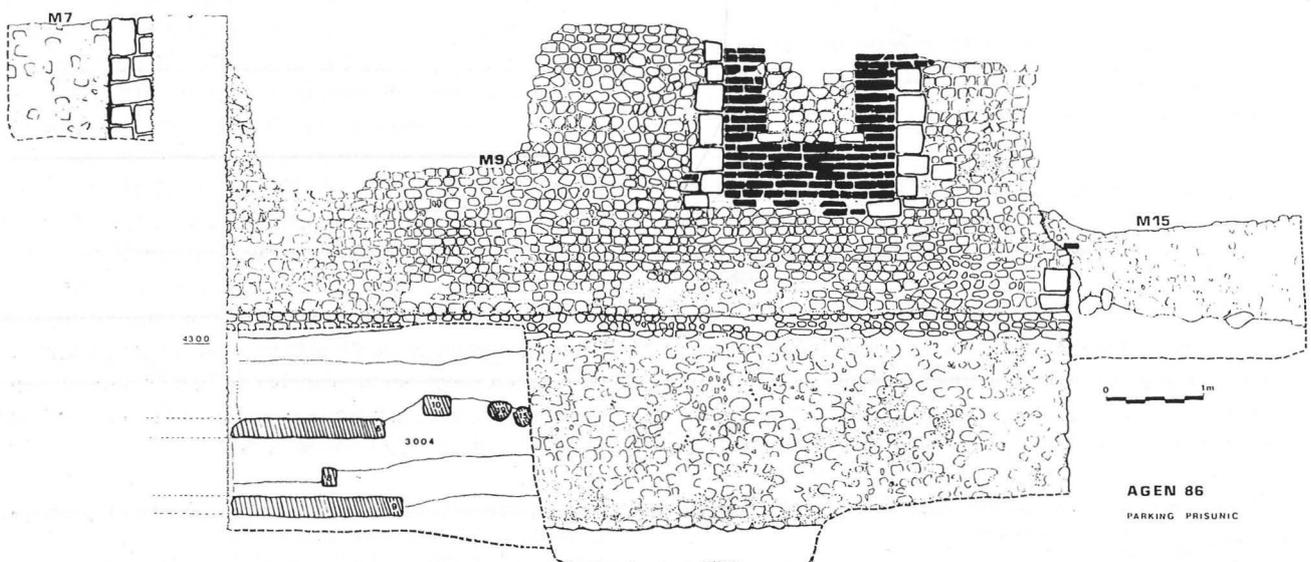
Elévation du mur (M9) du premier bâtiment ; en hachures, la plate-forme de bois (STB1) pouvait être un débarcadère. La mise en défense de la ville au XIII^e siècle est confirmée sur cette structure avec l'obturation de la porte par des briques et la construction simultanée des murs M7 et M15.
